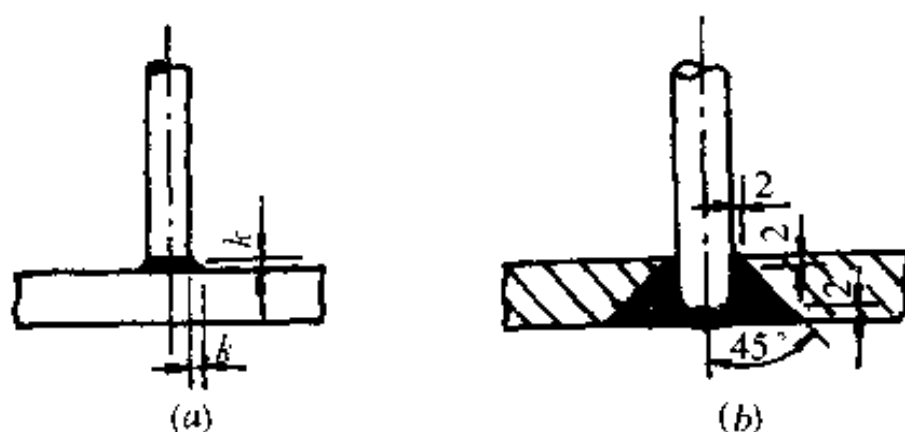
预埋件钢筋电弧焊 T 型接头
